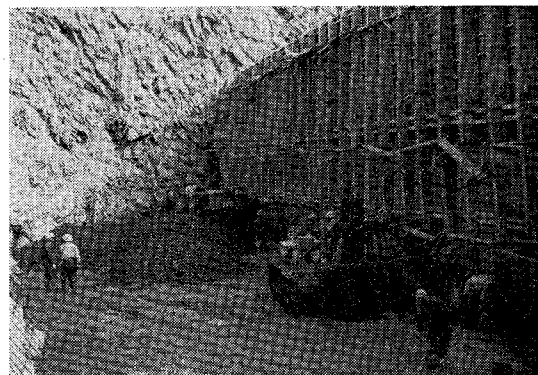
(3) 黒部ダムのパイプドローザ工法によるコンクリート打設状況
